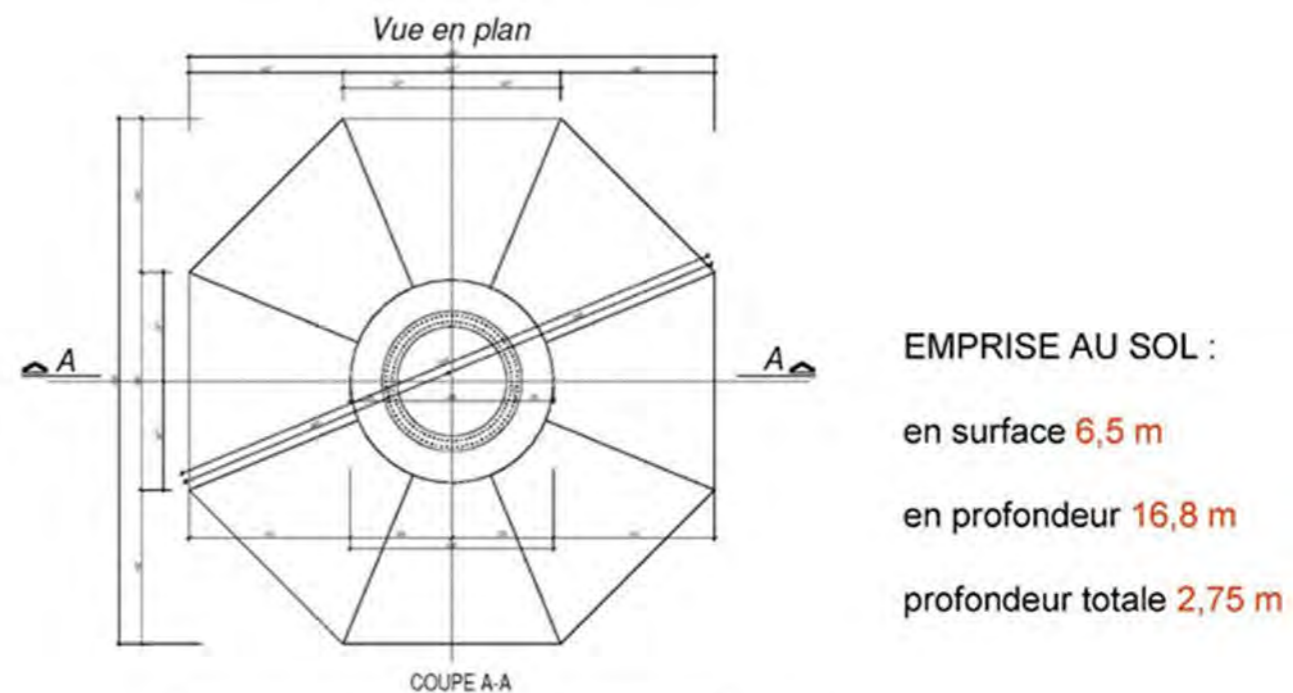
EXEMPLES DE FONDATION - (SOURCES : JPÉE, ING ENVIRONNEMENT)
